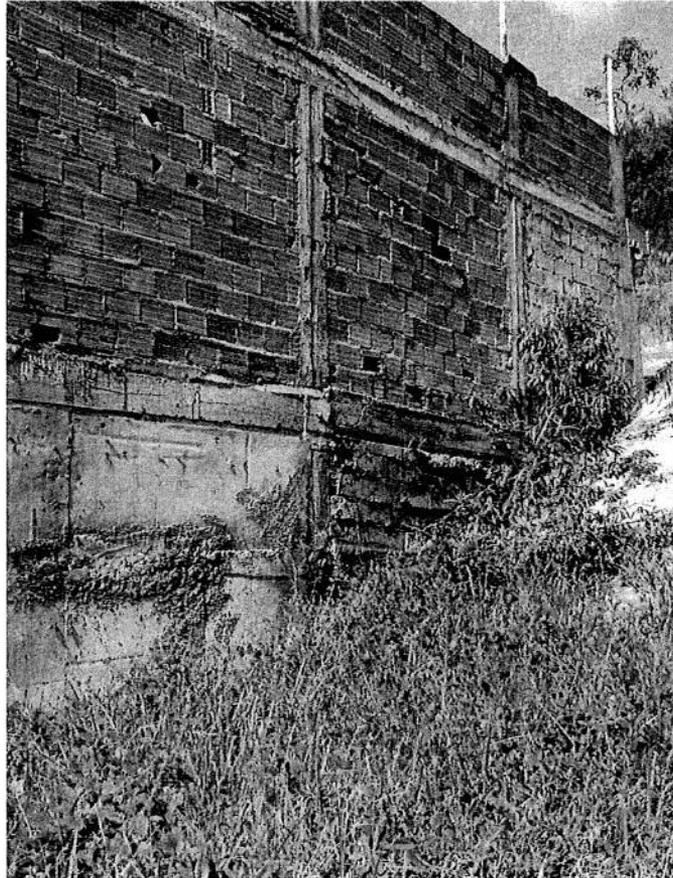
Vista lateral em 03/03/2022, casa s/n
